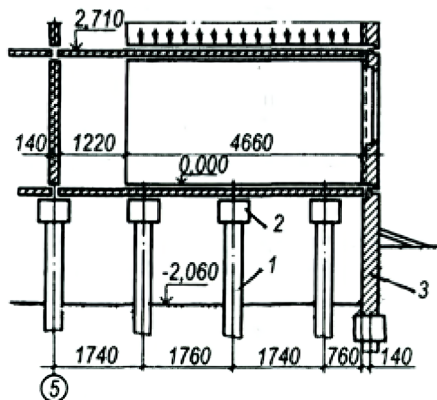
Безростверкові пальові фундаменти в панельних будівлях:
